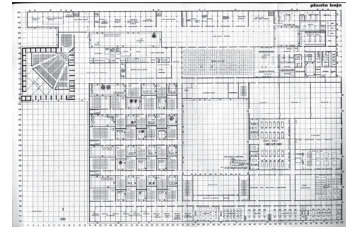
Universidad Laboral de Huesca. Laorga y L. Zanón. (*Informes de la Construcción*, 1971, 227).
